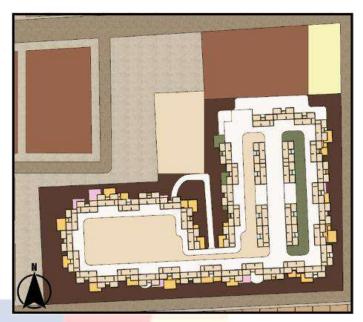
Denah Lantai 2 Gubahan Massa 1
